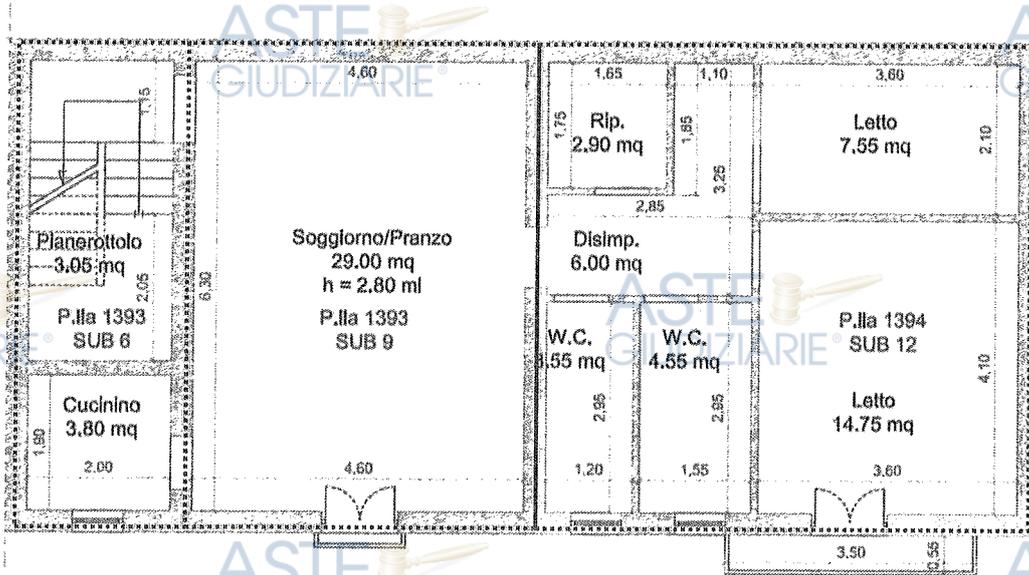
Planimetria Stato di Fatto Foglio 47, p.la 1393, sub 6-9, p.la 1394, sub 12 – Piano 1
